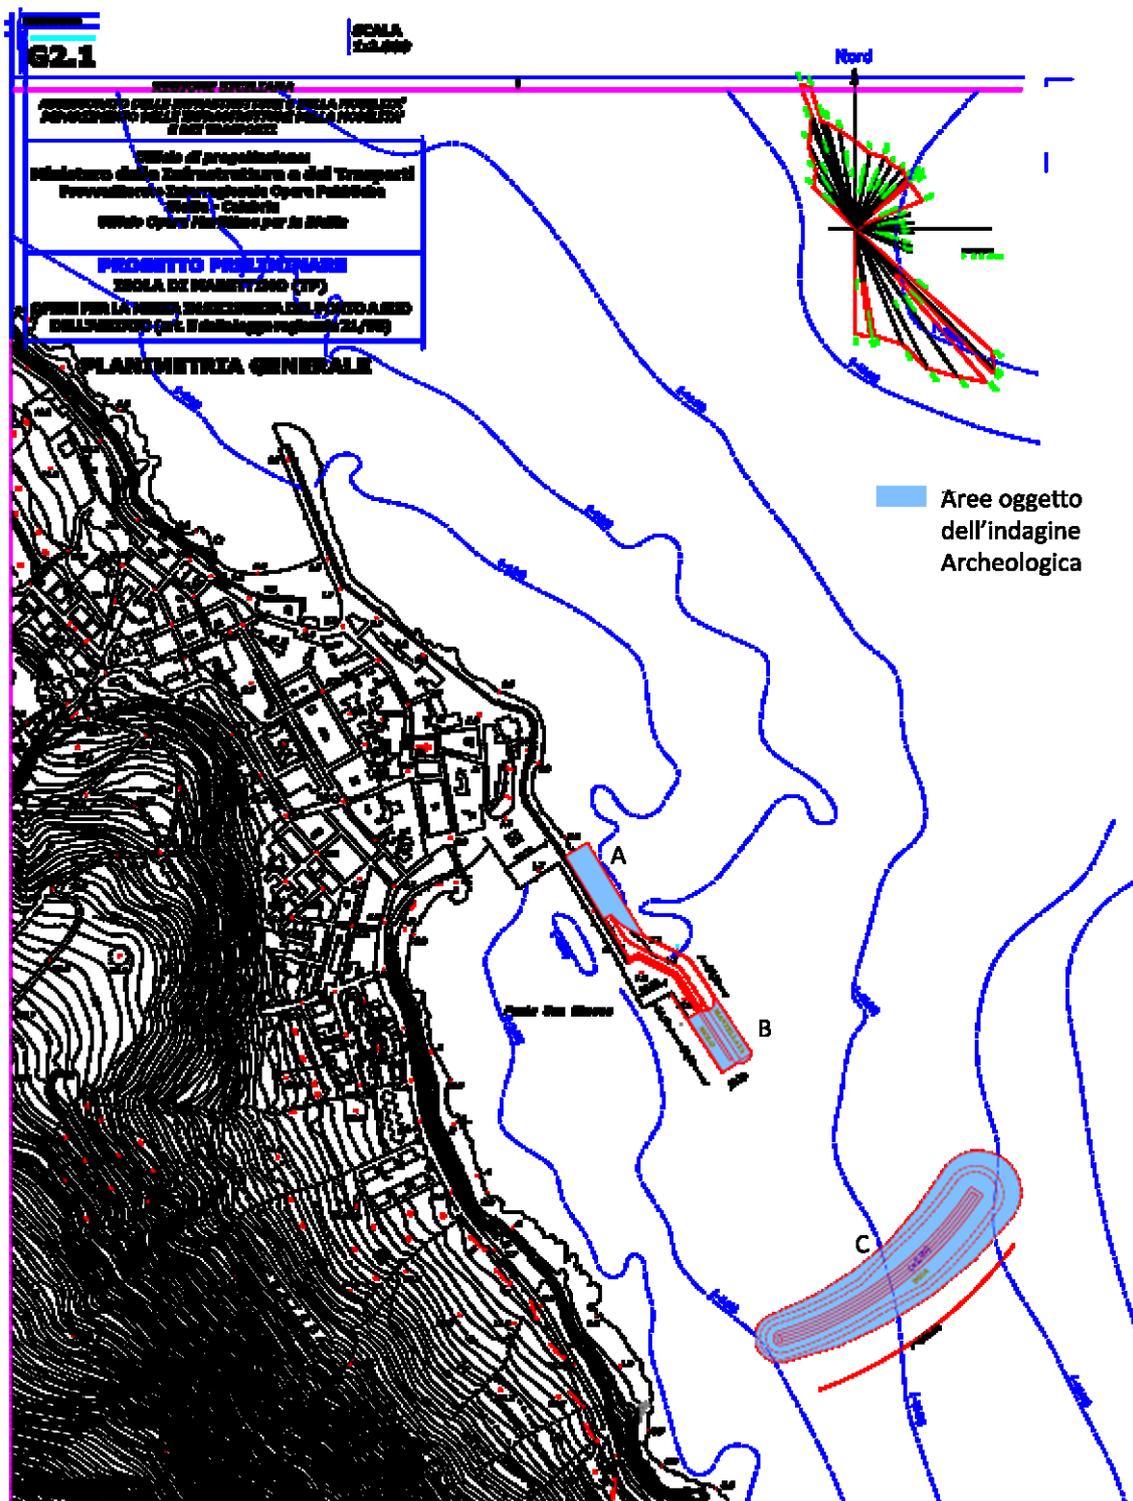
Planimetria dell'Area oggetto dell'Indagine Archeologica visiva e strumentale con indicazione delle opere in progetto evidenziate in azzurro – Scala 1:2000.
